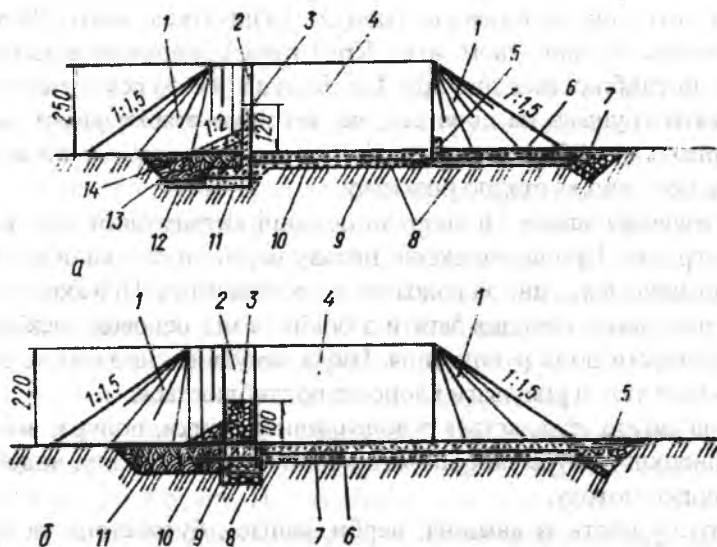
Залізобетонна та армована загата з кам'яної кладки без розчину: а – залізобетонна загата; 1 – конус; 2 – бічна стінка з Г-подібних блоків; 3 – водозлив з Г-подібних блоків; 4 – кріплення залізобетонними плитами; 5 – гаситель; 6 – ребристі залізобетонні плити; 7 – щебінь (дренажна призма); 8 – підготовка з щебеню; 9 – монолітний залізобетон; 10 – прокладка з толю; 11 – підготовка з бетону; 12 – фартух з толю; 13 – понур із суглинку; 14 – дренажна призма; б – армована загата з кам'яної кладки без розчину; 1 – конус; 2 – армокам'яна бічна стінка; 3 – армокам'яний водозлив; 4 – кріплення залізобетонними плитами; 5 – кам'яна призма; 6 – підготовка з щебеню; 7 – залізобетонні плити; 8 – фундамент з щебеню та кар'єрної дробини; 9 – монолітний бетон фундаменту; 10 – привантаження з каменю; 11 – понур із суглинку
